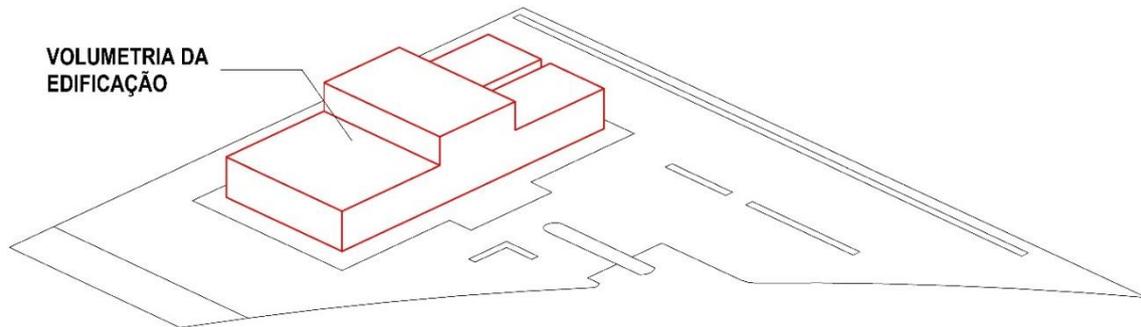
Vista em perspectiva do terreno e indicação da área da edificação
